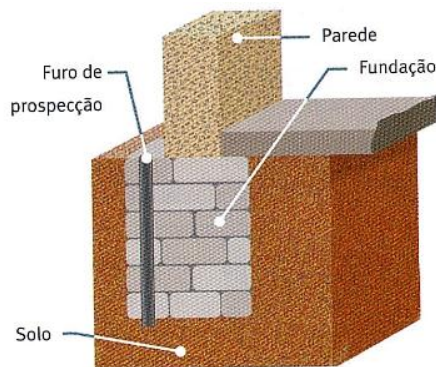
FURO DE SONDAÇÃO ATRAVESSANDO A FUNDAÇÃO [3].
